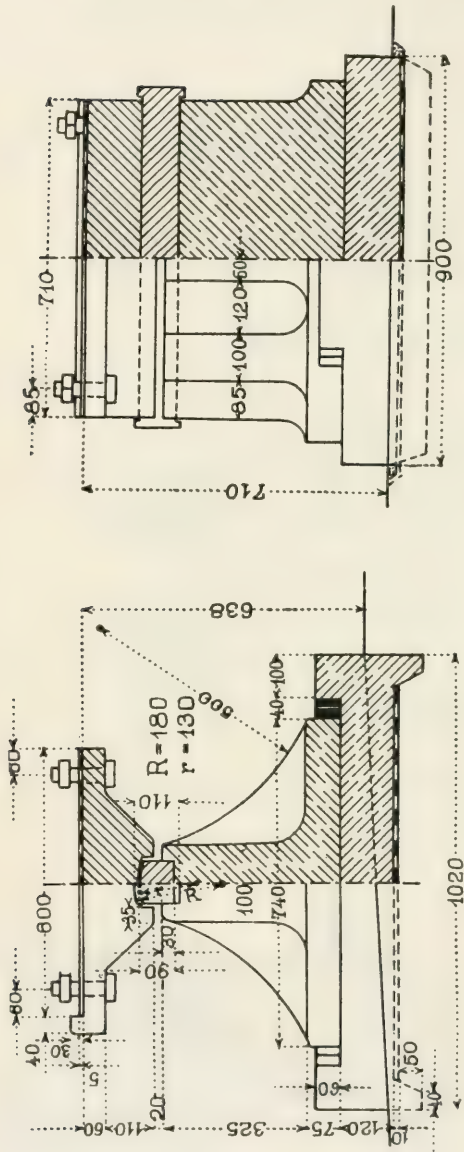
Festes Lager. Lager einer eingleisigen Eisenbahnbrücke von 76 m Stützweite.
